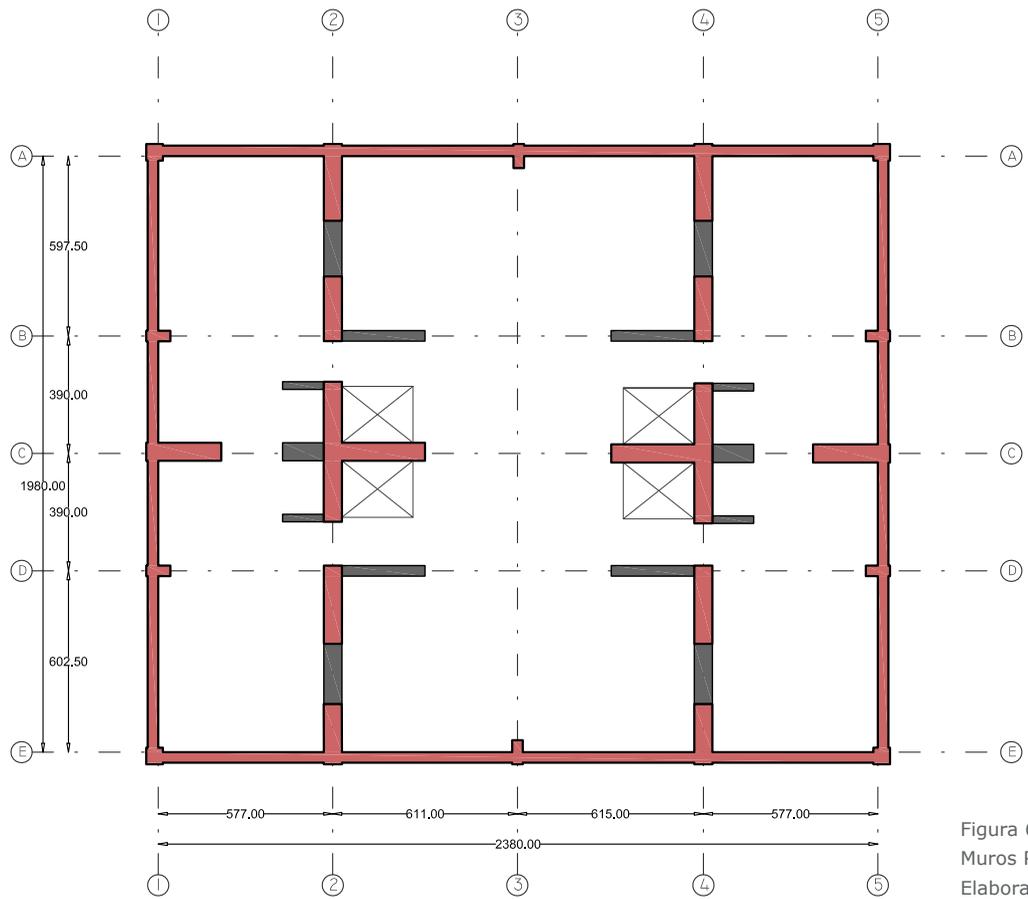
Demolición Muros Piso -2 y -1. Elaboración Propia
